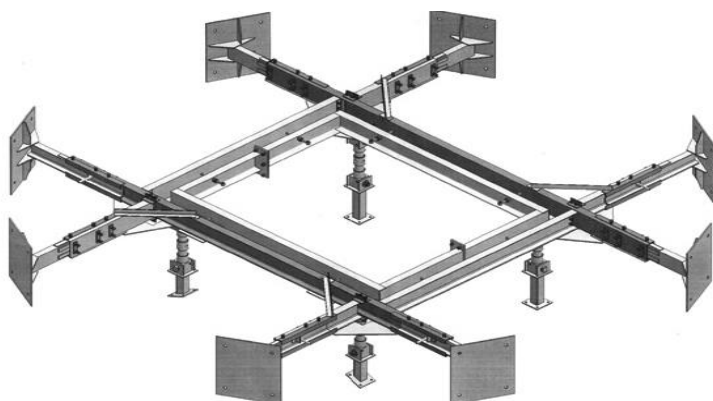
Конструкция опорного кронштейна крепления концов расстрела анкерами.
